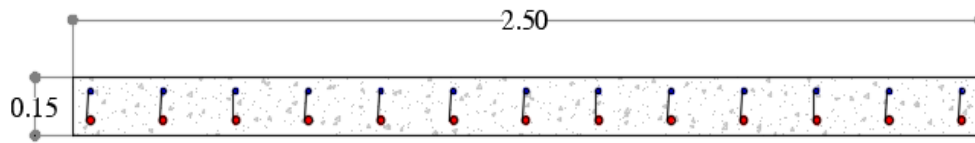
Armado del parapeto, análisis en sentido transversal (vista en planta)
